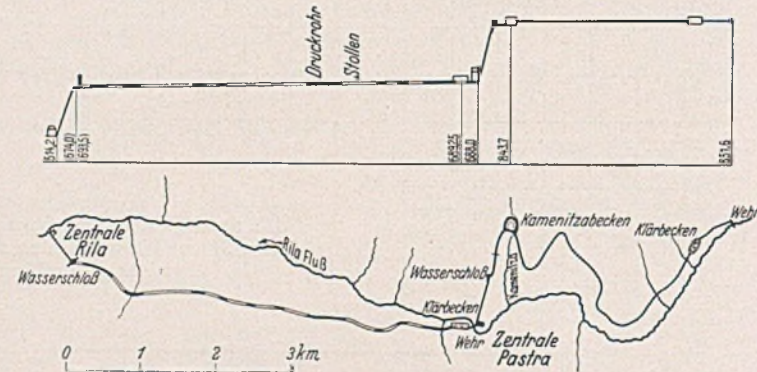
Lageplan und Längsschnitt der Anlage (aus „Granitoid Is-westija“).
